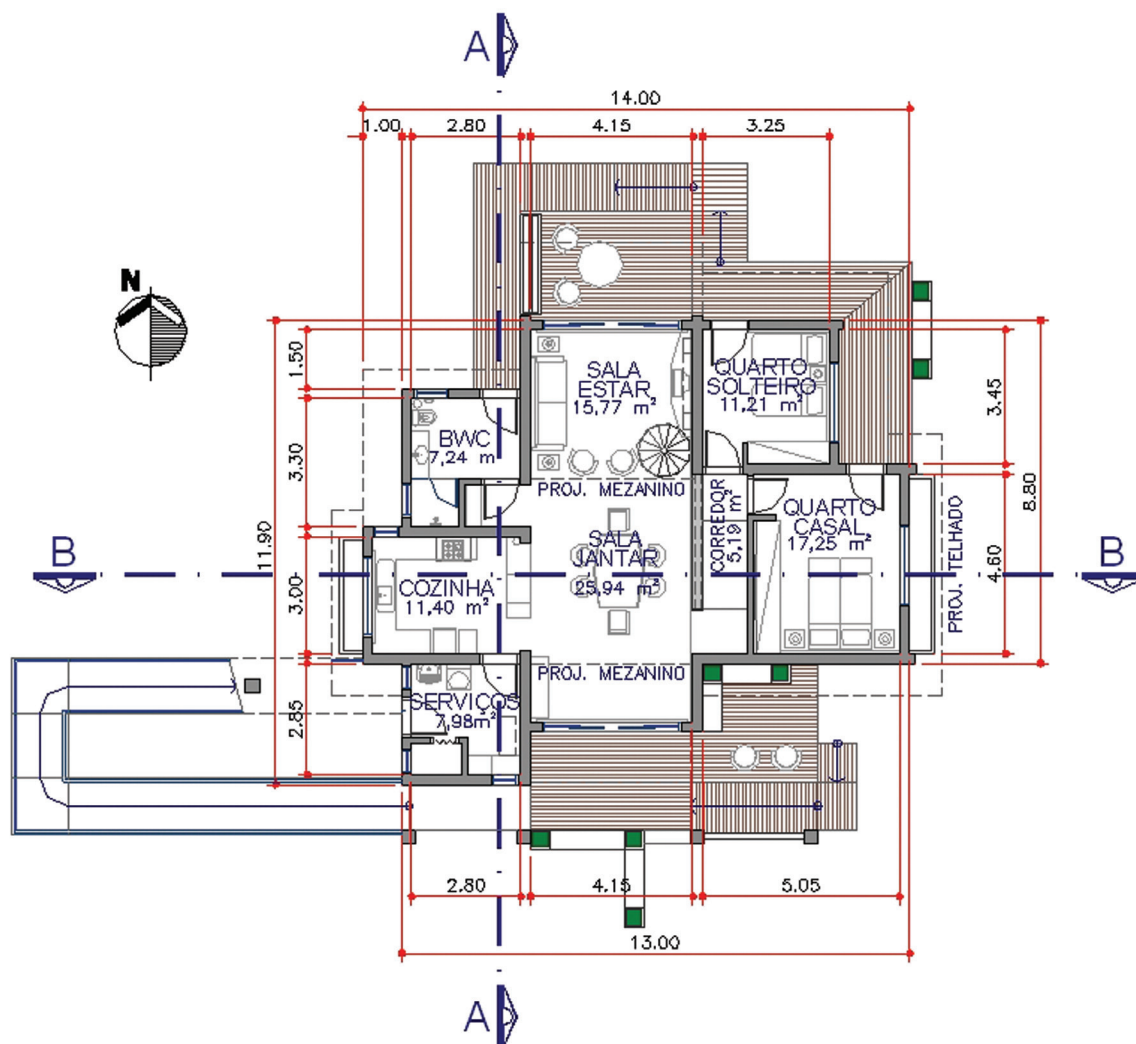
Planta baixa da Casa Eficiente – pavimento térreo.
